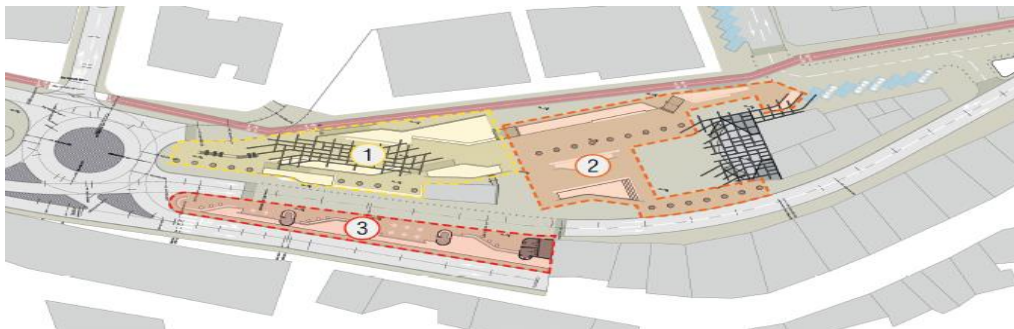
Plano en planta del proyecto LP 005 del 2021 Recuperado de: Planos Estudio Decimal para el municipio de Piendamó.
